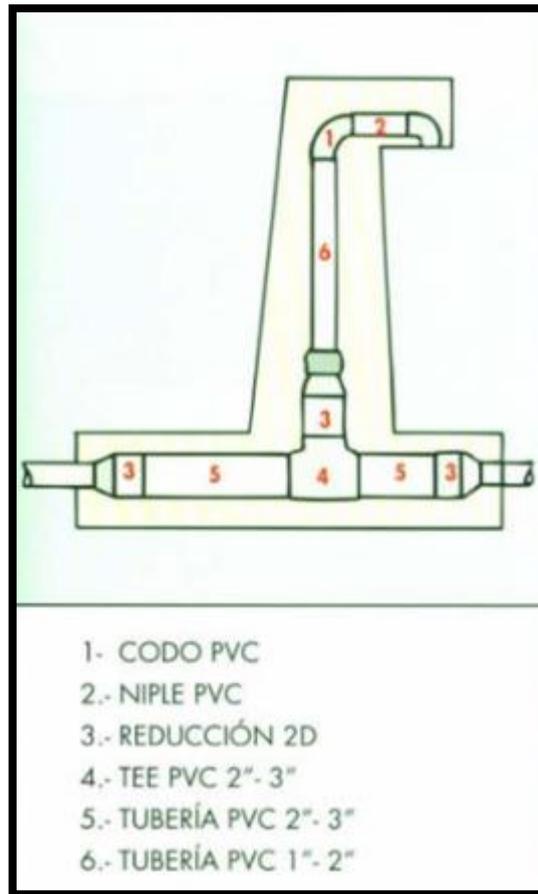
Plano en corte de Tubo Rompe Carga (TRC)
